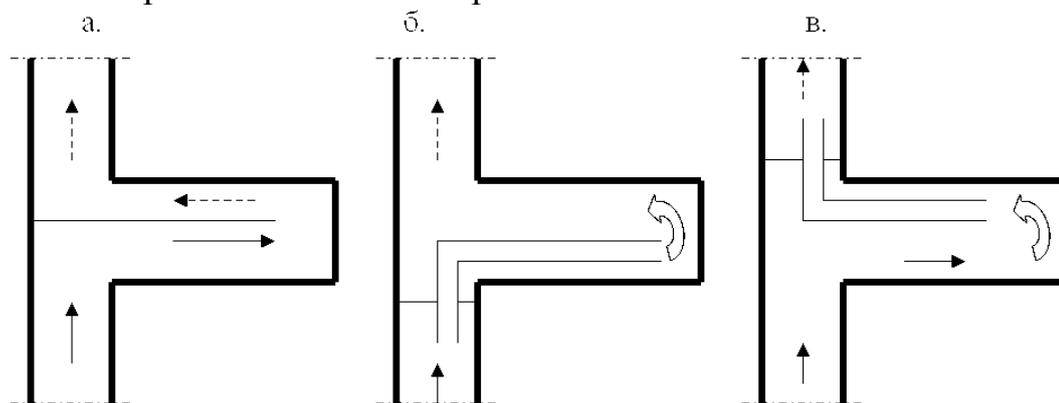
Схемы проветривания тупиковой выработки с помощью перегородки (а) и жесткой вентиляционной трубы (б, в)
